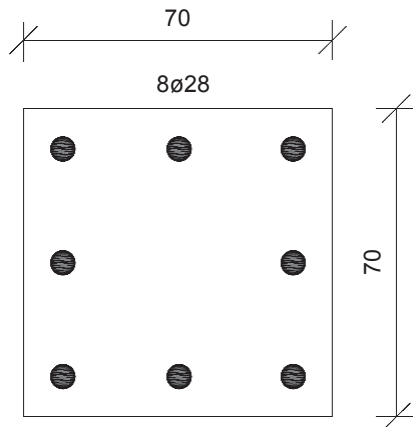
Refuerzo longitudinal columna 70x70 cm²
